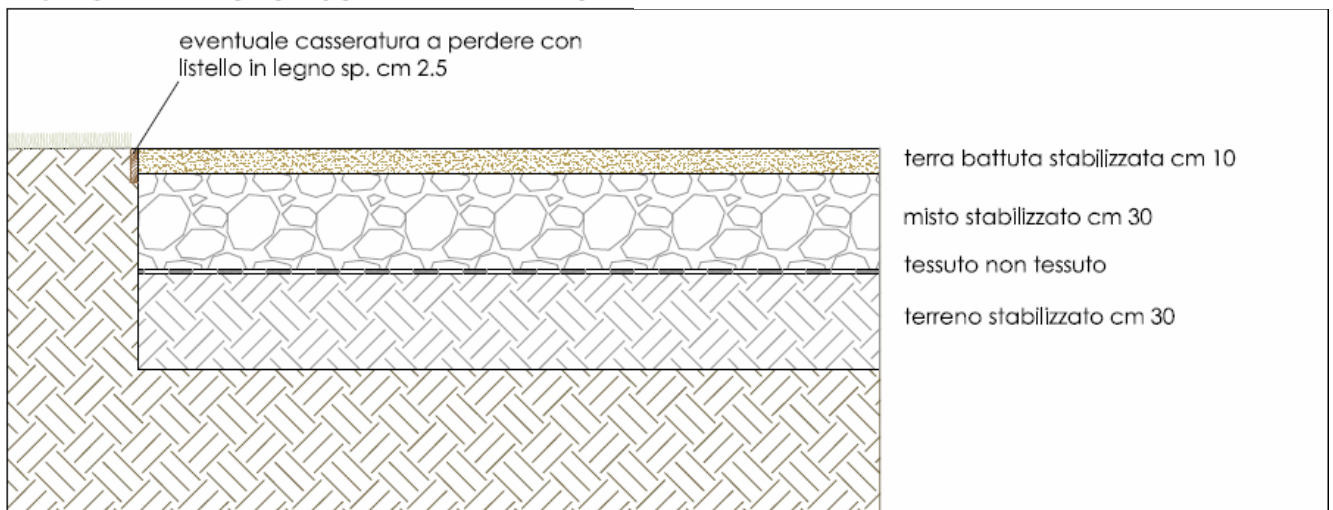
Pacchetto pavimentazione aree pertinenziali dei padiglioni
